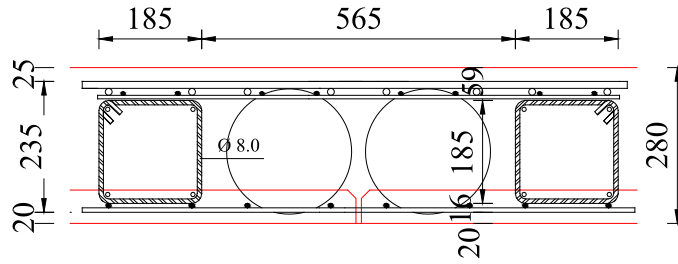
Detalhe da armadura de cisalhamento da laje BD2 (cotas em mm)
